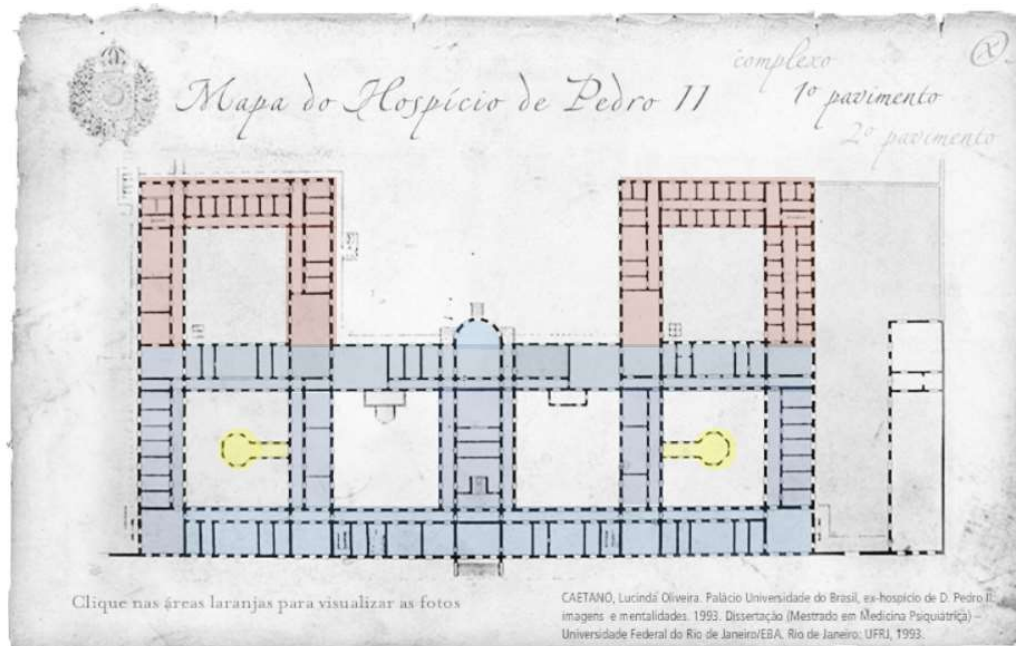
Planta do 1º pavimento indicando a construção original em azul, os acréscimos de 1890 em rosa e os torreões de vigilância em amarelo (1880). Fonte: Desenho da autora sobre Planta de Caetano (1993).
